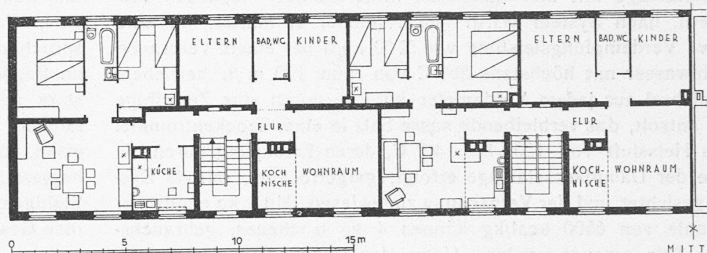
Grundriss-Typen des Ziegelmauerwerk-Baublocks. — 1 : 300.
